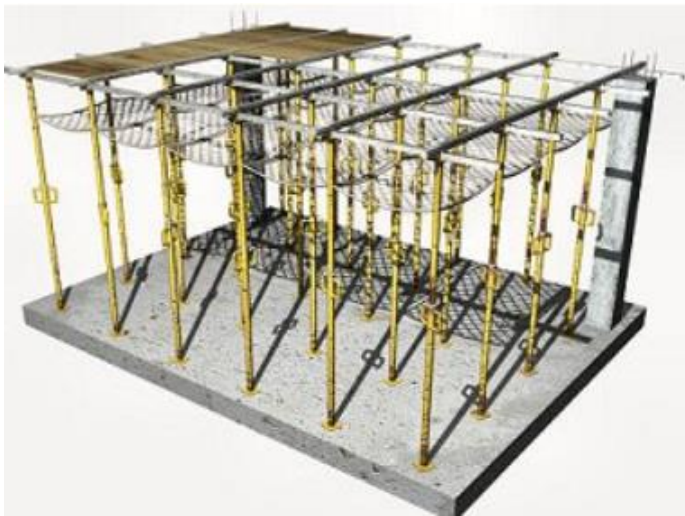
PRINCIPE DU COFFRAGE D'UNE DALLE RETICULEE A CAISSONS PERDUS
